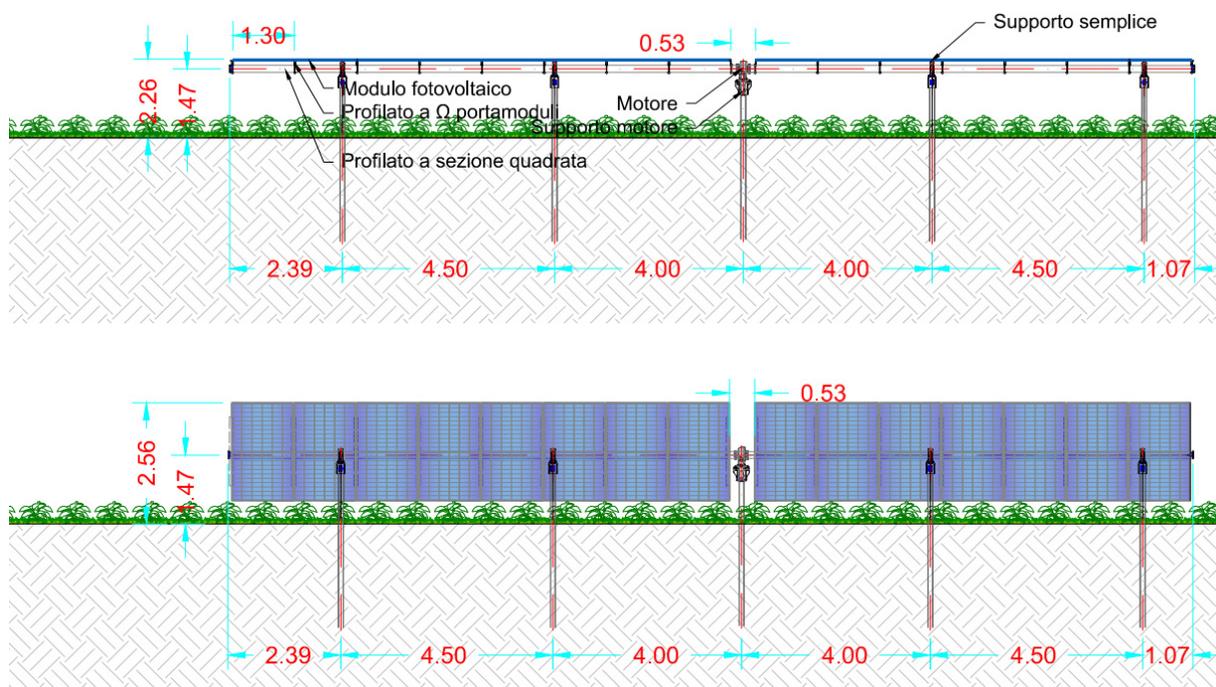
Sezione longitudinale tipologica struttura Tracker
